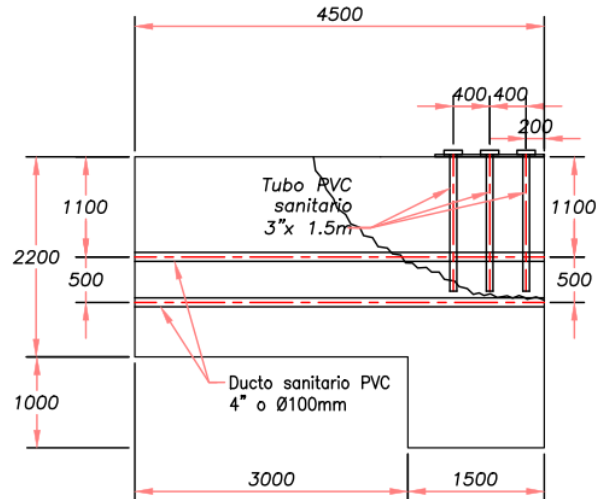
Vista en elevación de cámara de anclaje de retenida de Puente
